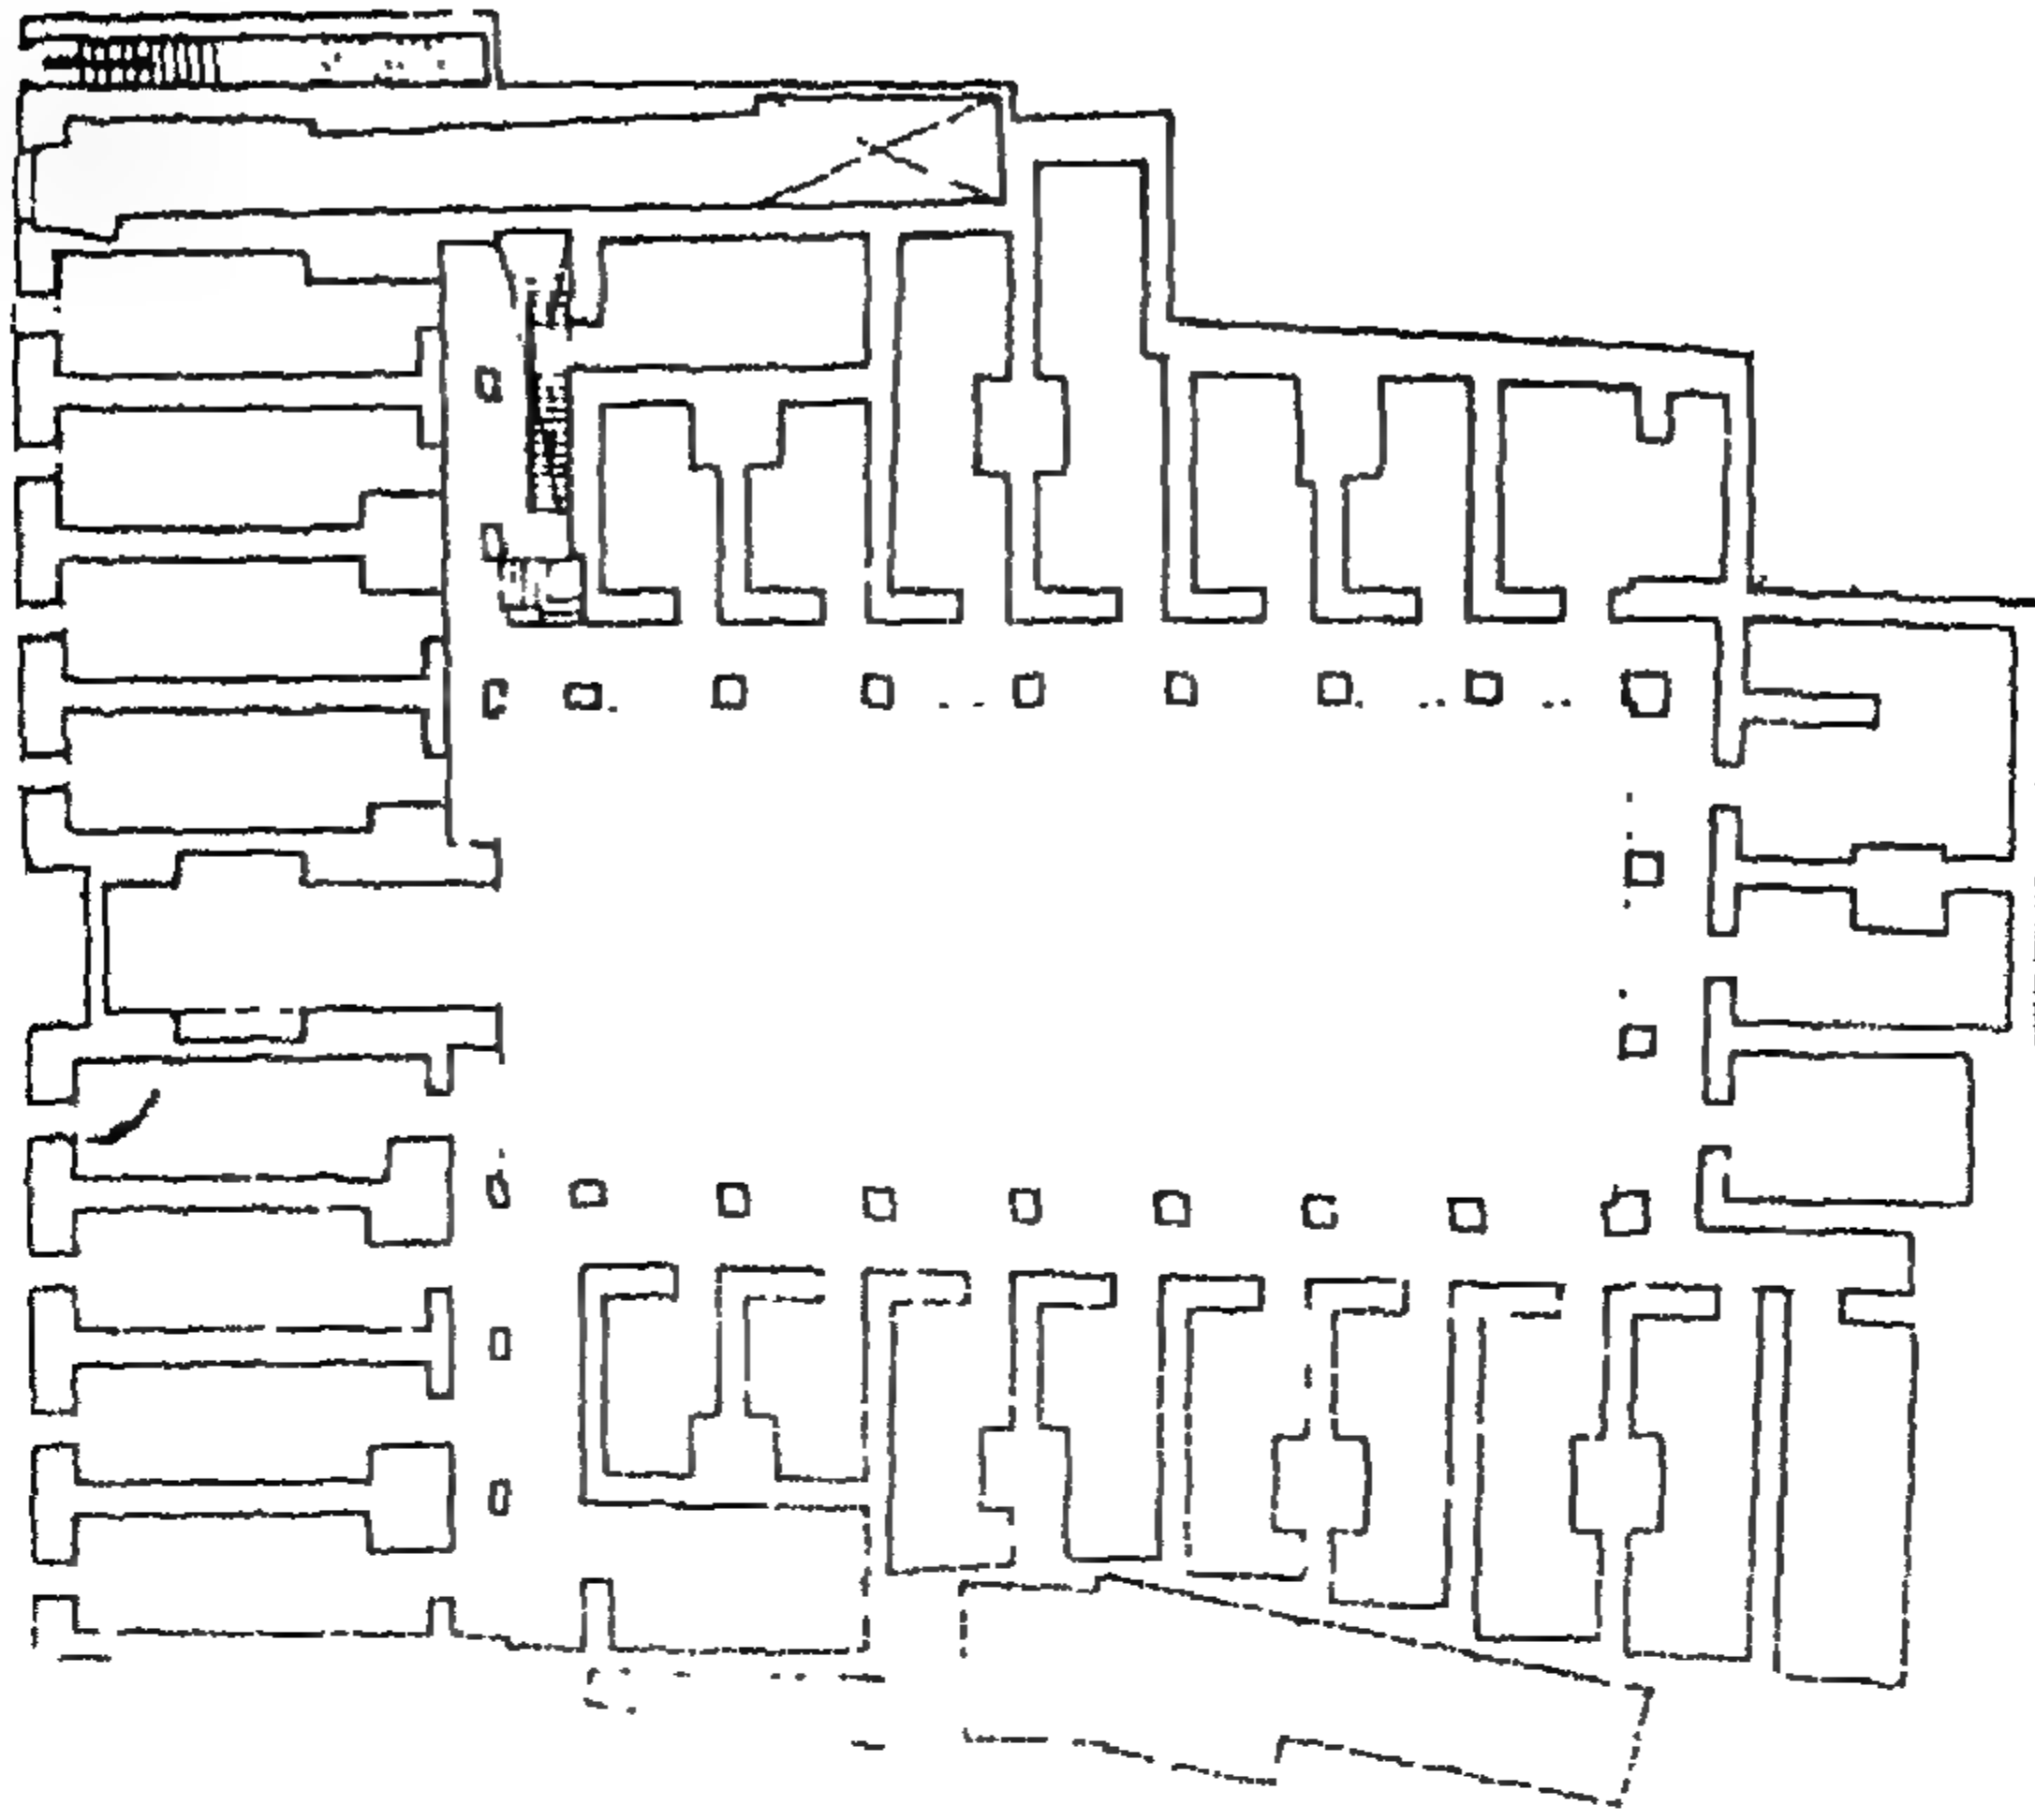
مسقط أفقي لحمام الملاطيلي بالقاهرة. (عن : Pauty) .
